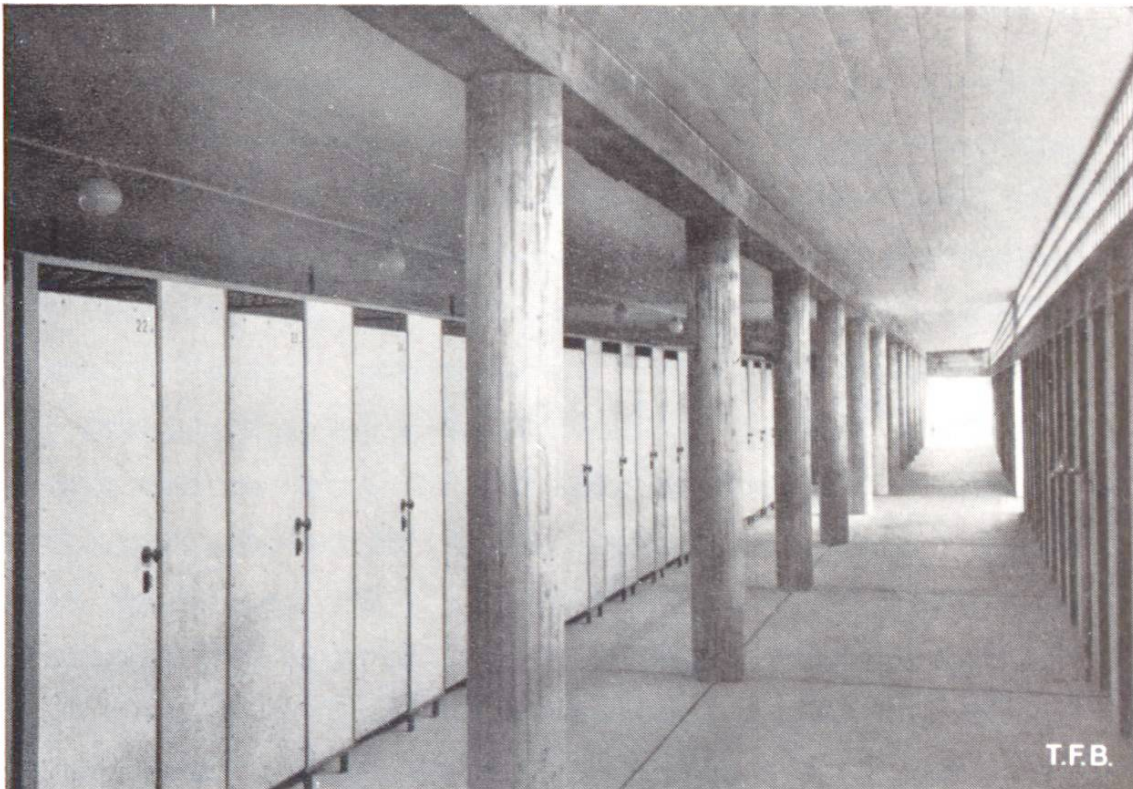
Schwimmbad Olten. Innenansicht der Kabinenhalle. Betonbelag. Pfeiler, Unterzug und Decke in schalungsrohem Eisenbeton. Kabinenfront (Türen und Wandverkleidungen) aus Eternit
